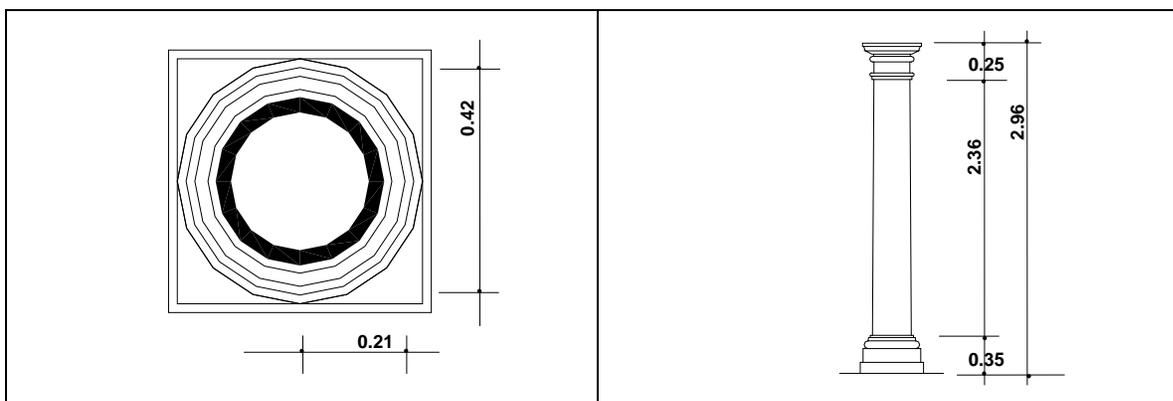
Diámetro y radio a la altura del imoscapo de columnas en planta baja, Palacio Episcopal.
